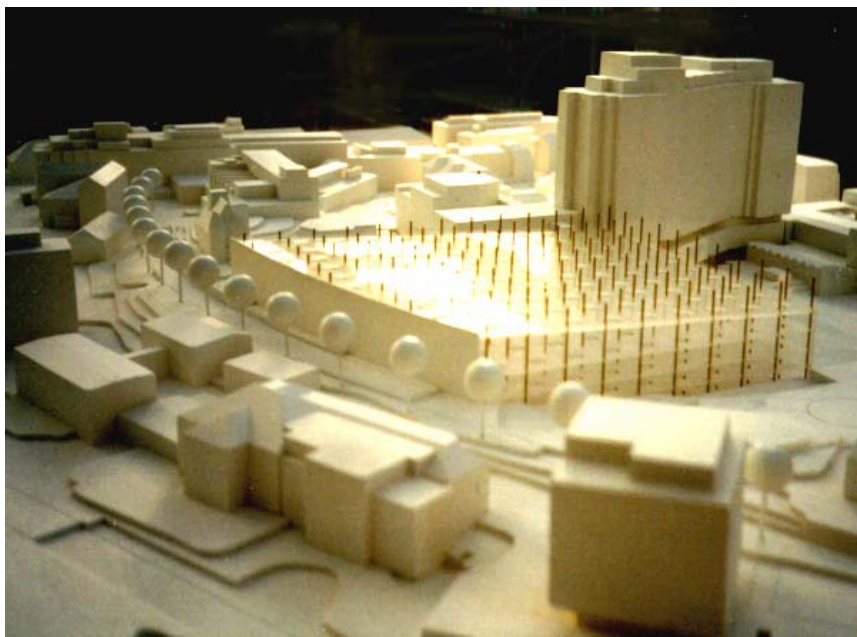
Ausgangspunkt der Ergonomiestudie: Die Gebäudehülle (Primärsystem) ist entschieden, das Raumlayout als innere Struktur (Sekundärsystem) ist noch nicht geplant, sondern erst zum Wettbewerb ausgeschrieben. Photographie des Siegerprojektes (Baukörper in Bildmitte) für das INO-Primärsystem.
